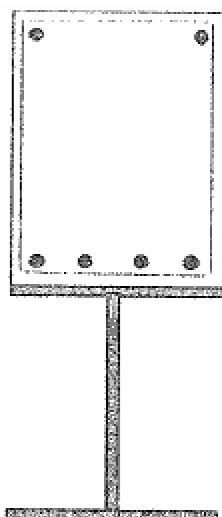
Reforço por colocação de viga metálica (Carreira, 2000).
